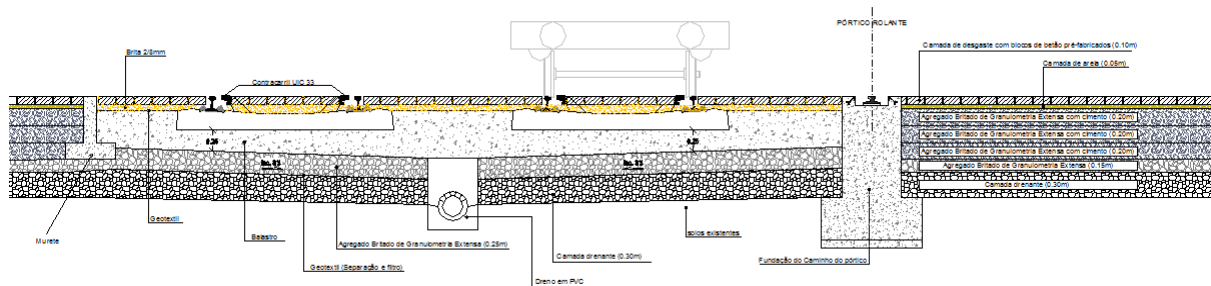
Perfil Transversal tipo Ferroviario [13]
